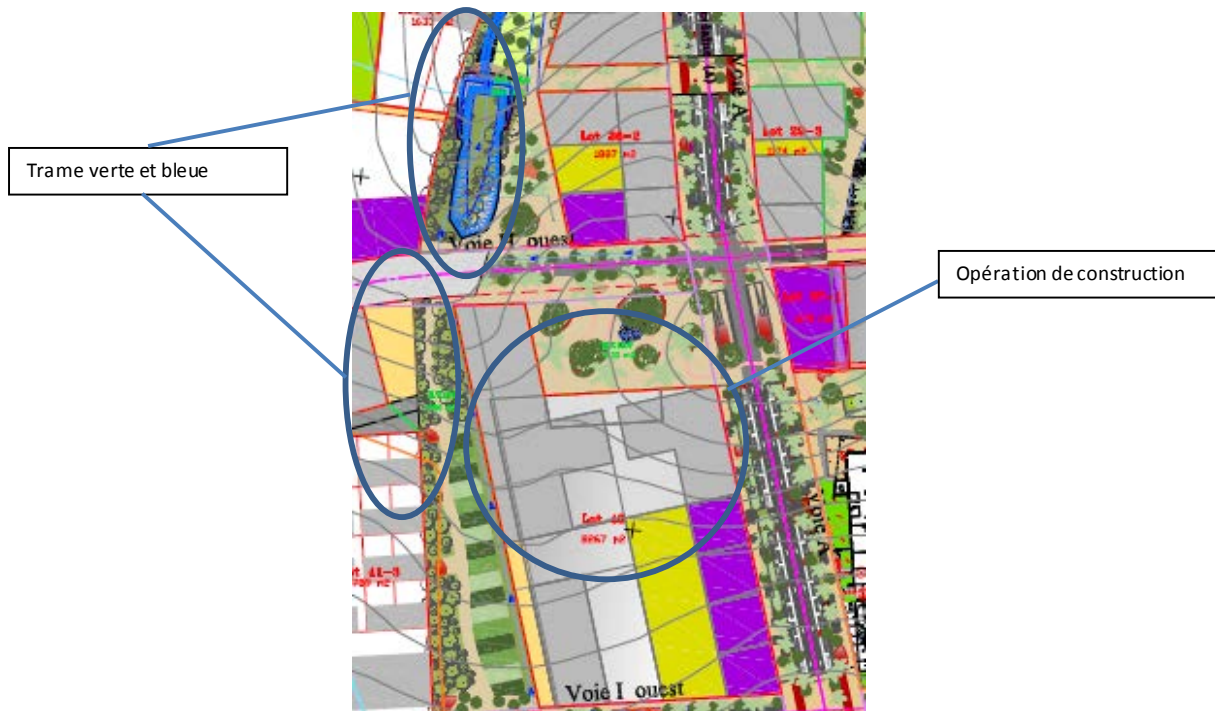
Gestion des eaux pluviales îlots 40 de Beauséjour (fond de plan Tekhnê architectes)
